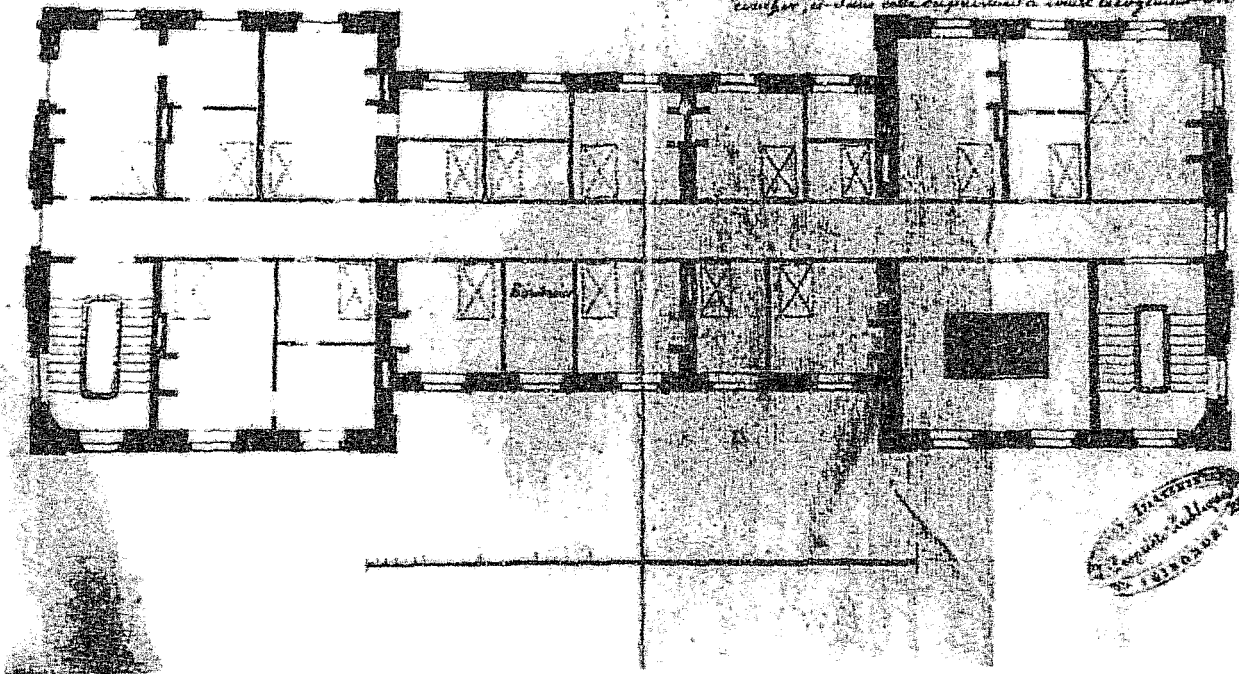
Premier projet du Château d'Arsac. Plan du premier étage.
